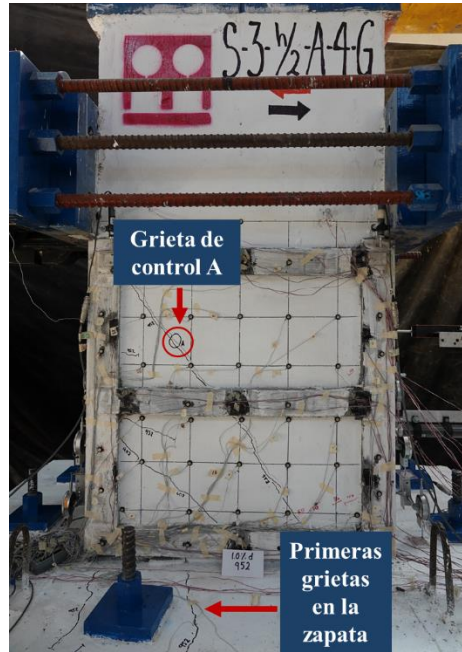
Definición de la grieta de control A y aparición de las primeras grietas en la zapata en la cara Norte (ciclo 3, distorsión +1%).
